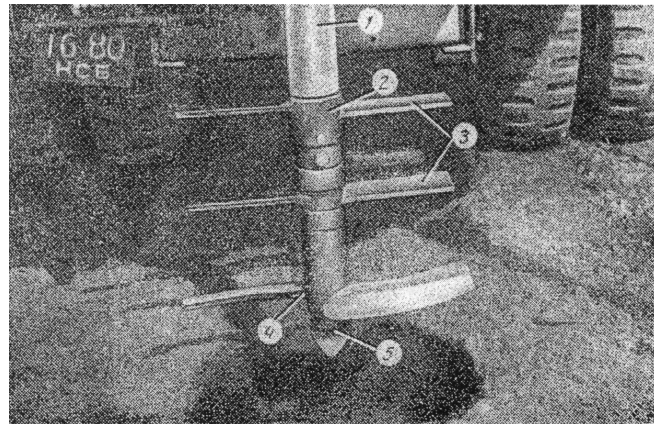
Загальний вигляд робочого органу агрегату АГС-7
